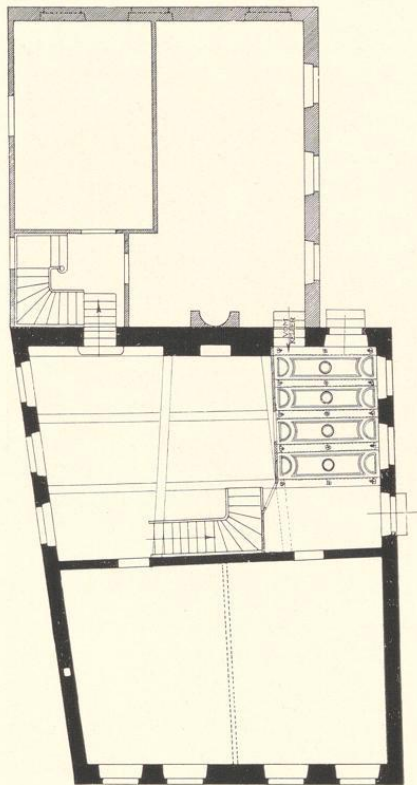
Grundriß des Erdgeschosses des Hauses Neubrückenstraße 12/14; Maßstab 1 : 200
